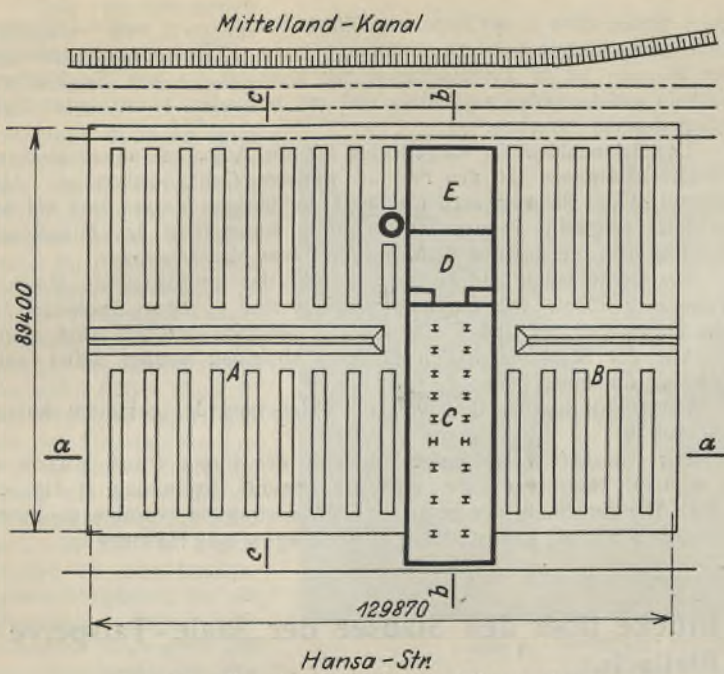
Grundriß in Höhe der Obergeschosse.
